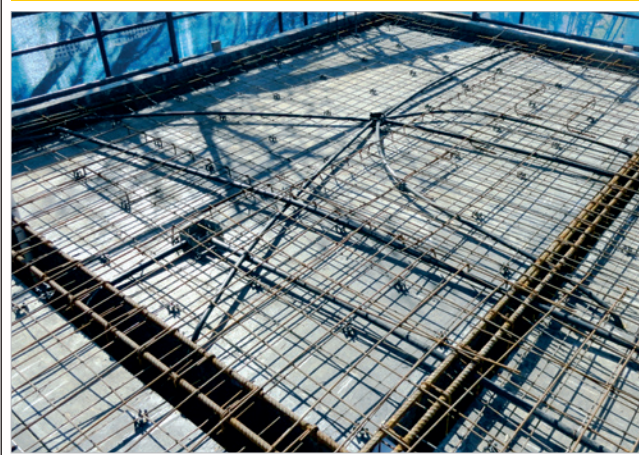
Disposição dos espaçadores espaçados 60 cm na obra antes da concretagem
